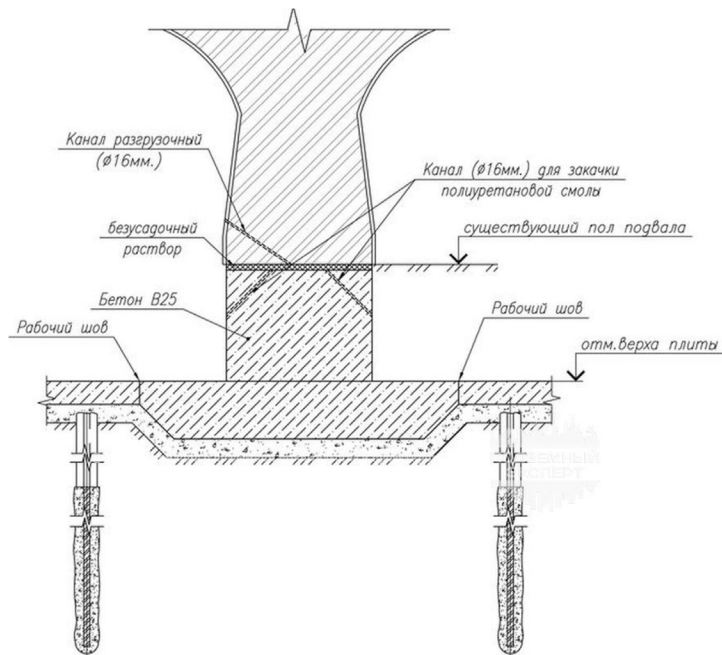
Разрез (схема) монолитного железобетонного свайного фундамента по технологии GEOIZOL-MP, подведенного под кирпичную колонну в цокольном этаже Александровского дворца в г. Пушкине
